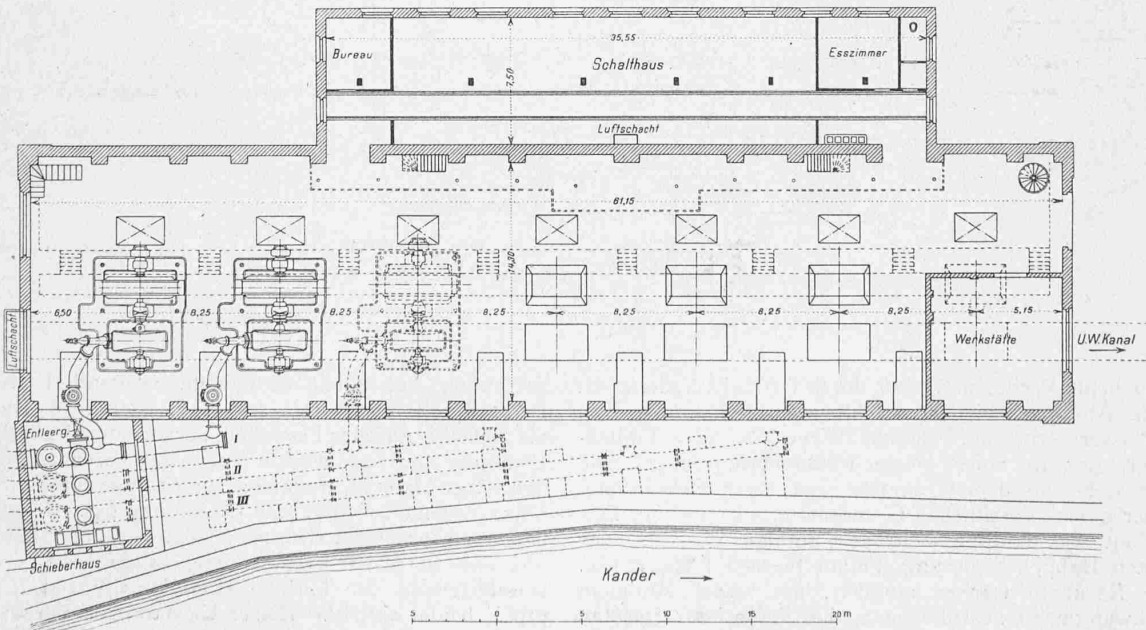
Grundriss der Zentrale des Elektrizitätswerks Kandergrund. — Masstab 1 : 400.
